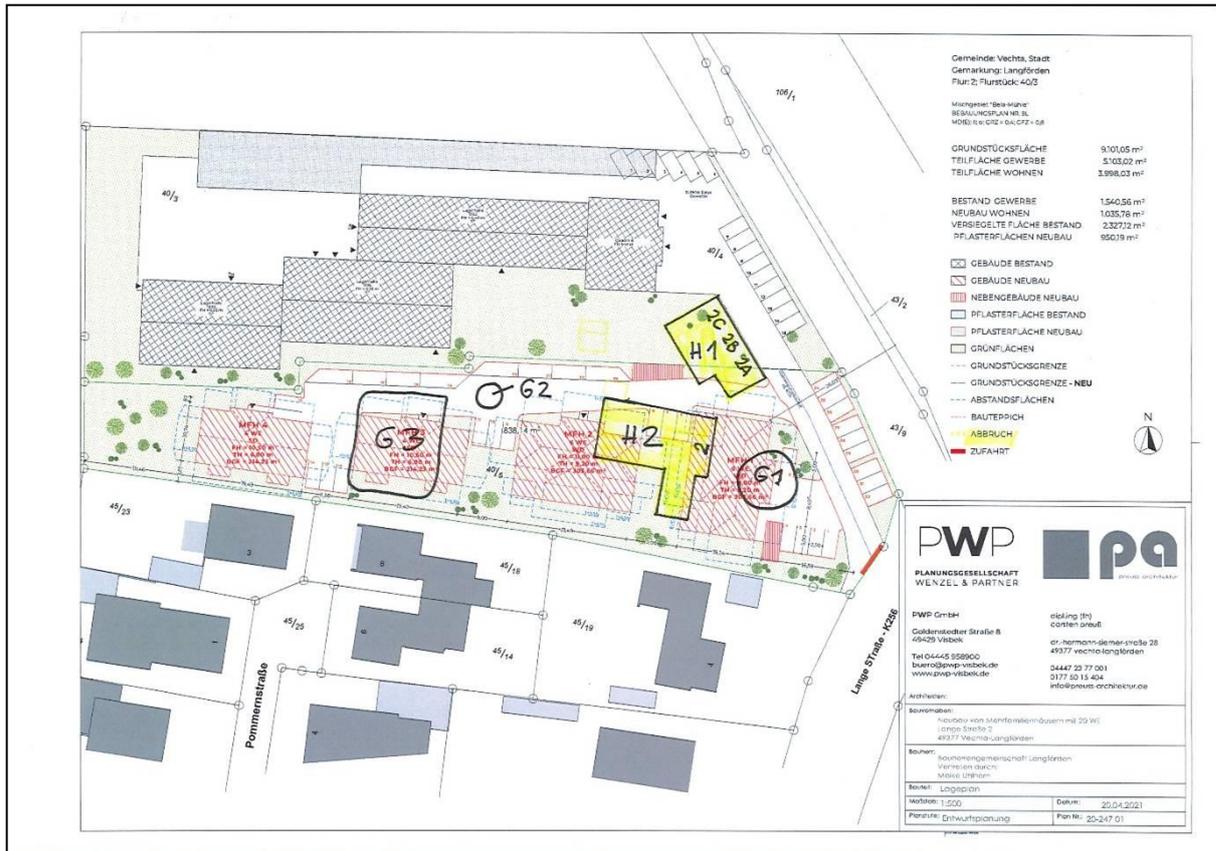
Geplanter Neubau von Mehrfamilienhäusern (rot) und Lage der vom Abriss betroffenen Gebäude H1 und H2 (gelb) sowie ungefähre Lage der auf dem Grundstück angetroffenen Gewässer (G1 /Gartenteich, G2 /Gartenteich, G3 /Regenrückhaltebecken)
